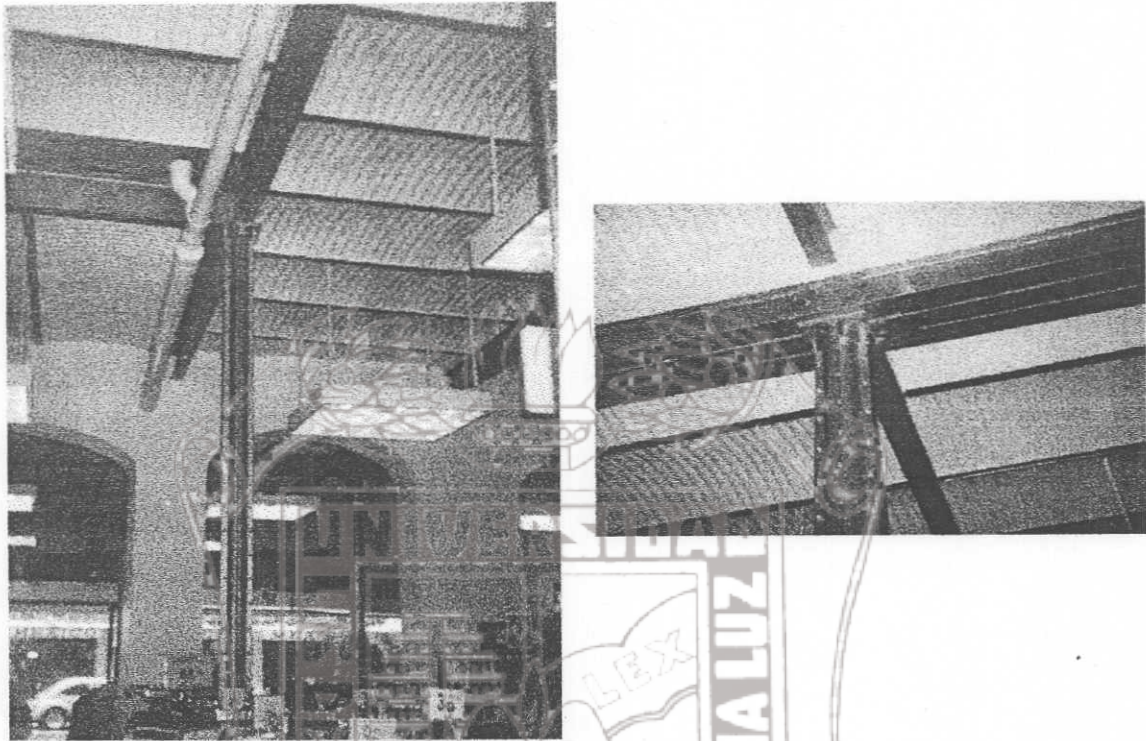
Columnas y vigas de acero que soportan un entrepiso de bóveda catalana.
